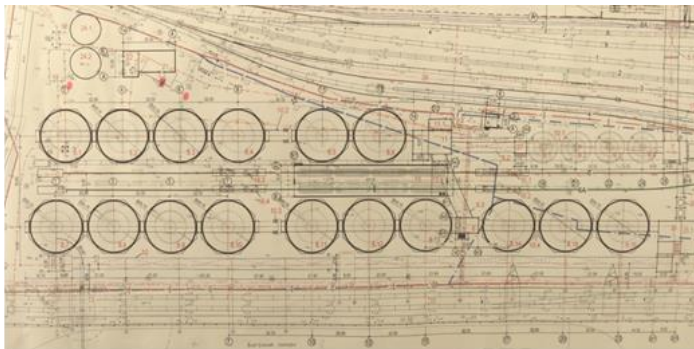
Фрагмент генплану забудови комплексу споруд башт силосів
